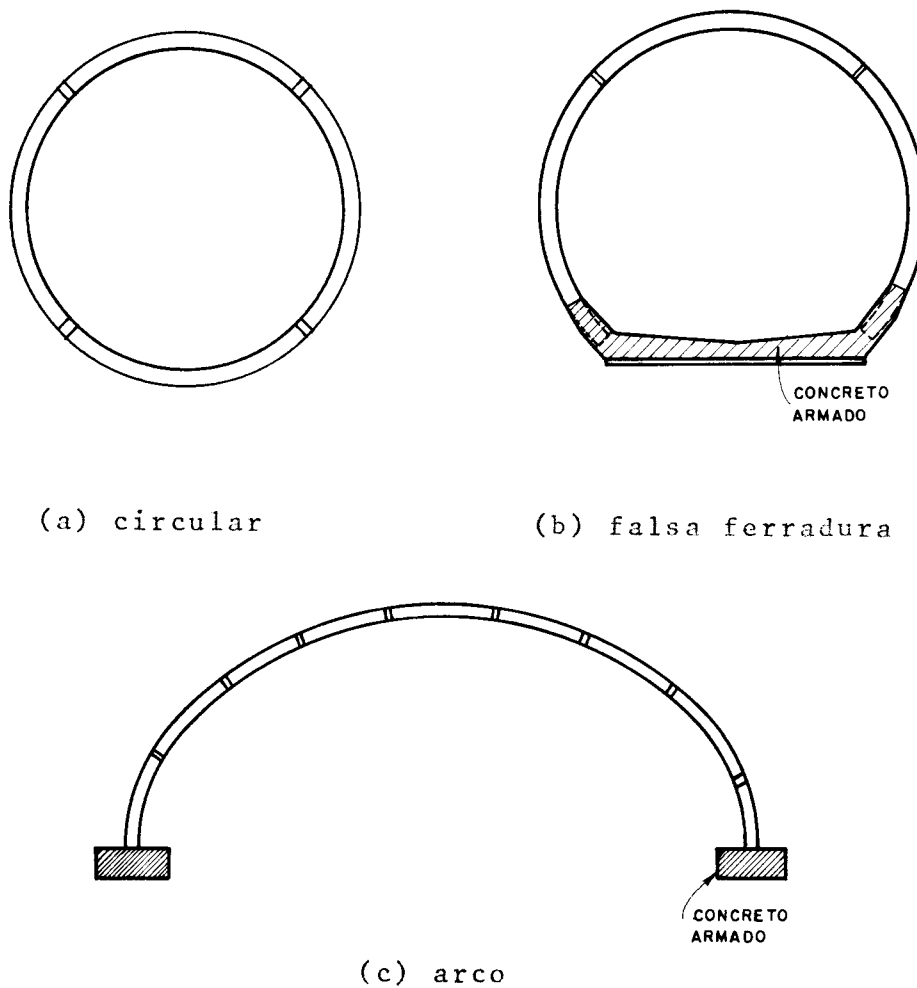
Seções transversais para as galerias em argamassa armada.
